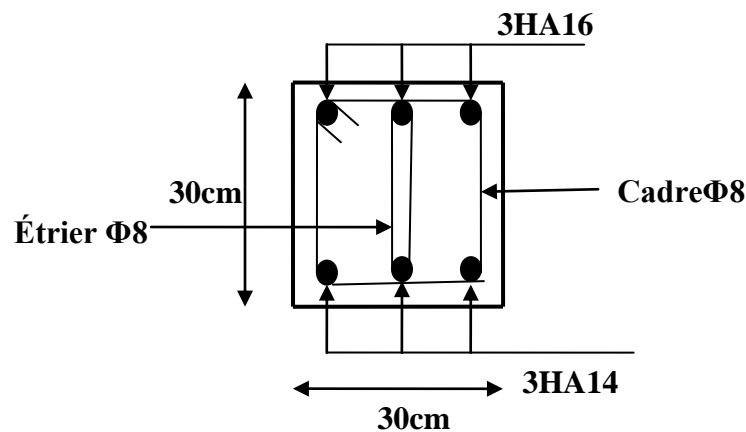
Ferrailage de la Poutre palière (travée et appui)
